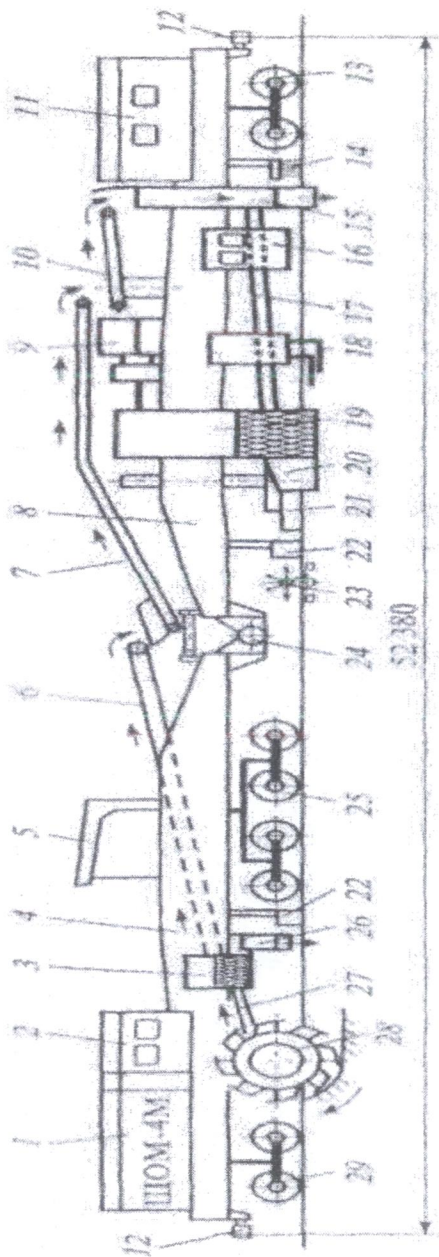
Схема щебнеочистительной машины ЩОМ-4М: 1- дизель электрический агрегат; 2 и 16 – кабины управления; 3 и 19 – дополнительный и основной центробежные грохоты; 4 и 8 – направляющая и рабочая секции; 5 – кран-укосина; 6, 7, 10, 17 и 27 – конвейеры; 9 – привод основного грохота; 11 – кабина хозяйственная; 12 – автосцепка; 13, 25 и 29 – ходовые тележки; 14 и 22 – шпальные и рельсовые шетки; 15 и 26 – дозирующие устройства; 18 – планировщик балласта; 20 – подгребающее крыло; 21 – ПРУ; 23 – устройство для пробивки балласта в шпальных ящиках; 24 – сферический шарнирный узел; 28 – роторное торцевое вырезное устройство
